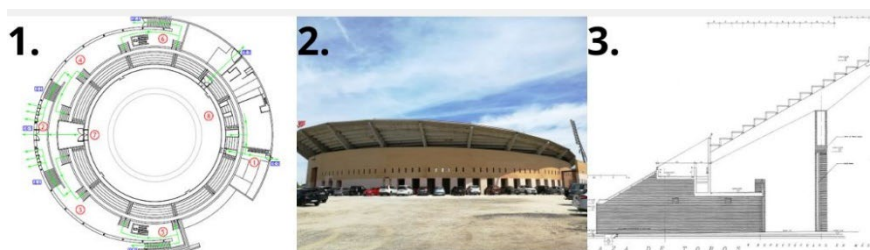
(1) Plano de Evacuación del Graderío. (2) Vista Exterior Edificio. (3) Sección Tribuna
